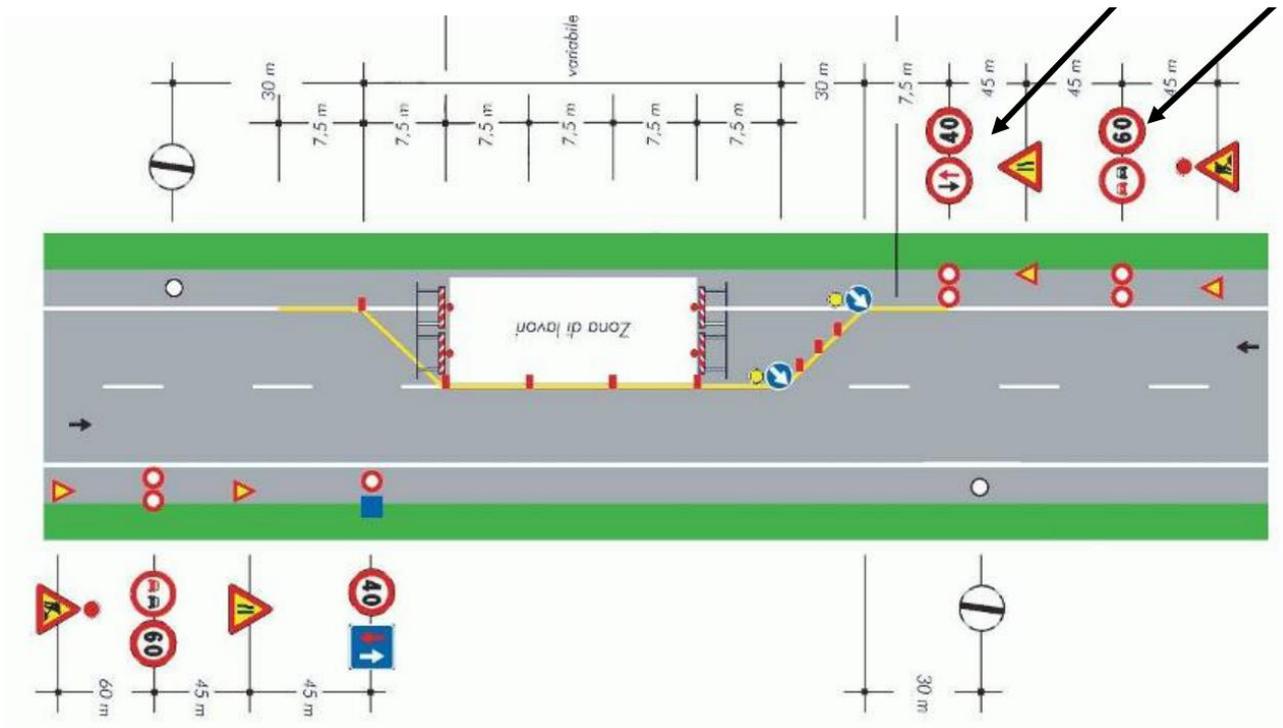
17 - Esempio cantiere stradale con limitazione della velocità con senso unico alternato a vista
